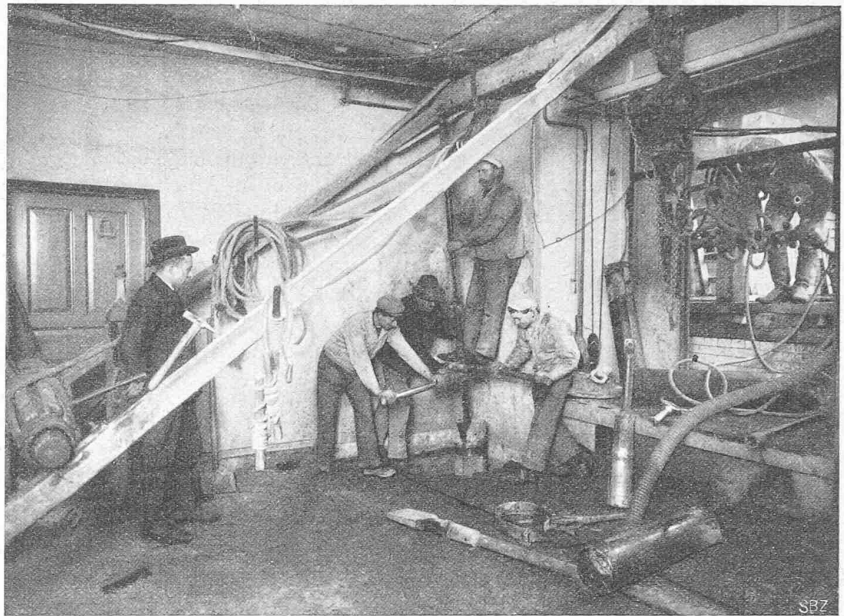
Strausspfahl-Bohrung in einer Kellerraum-Ecke, dicht an den Wänden.
